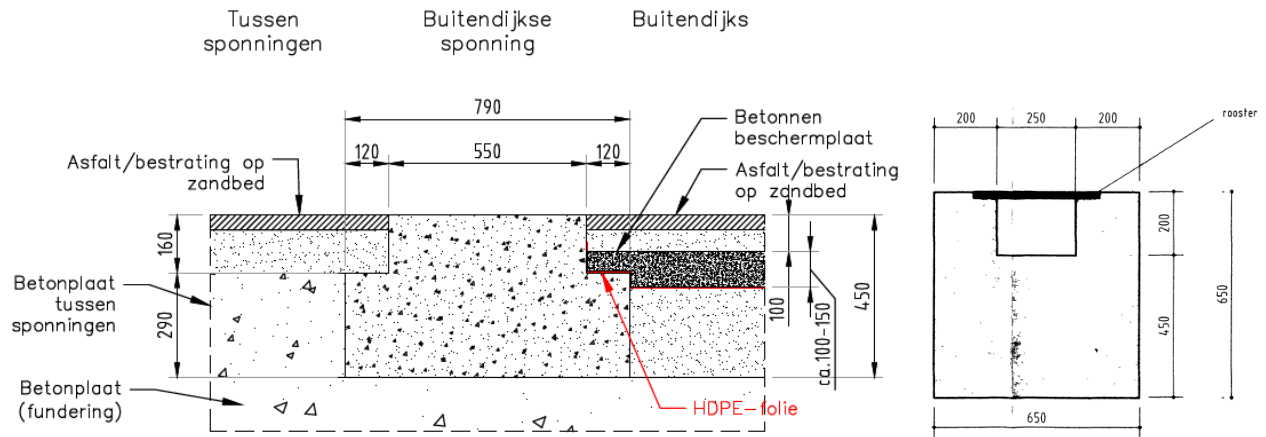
Inspectietekening met in het rood de betonplaat (zie [7] Bijlage 1)
